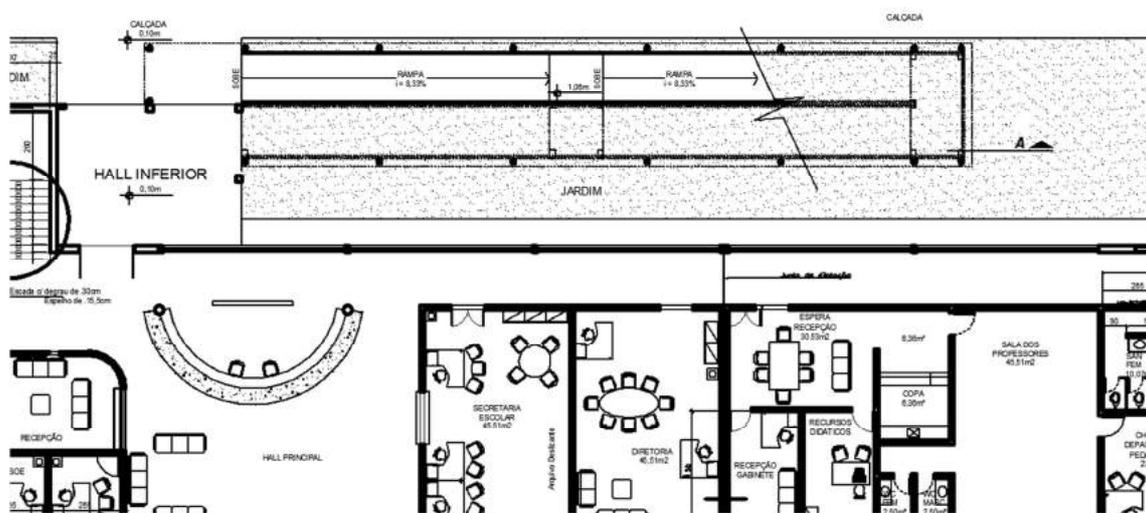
PAVIMENTO INFERIOR - BLOCO PEDAGÓGICO – CAMPUS PLANALTINA
